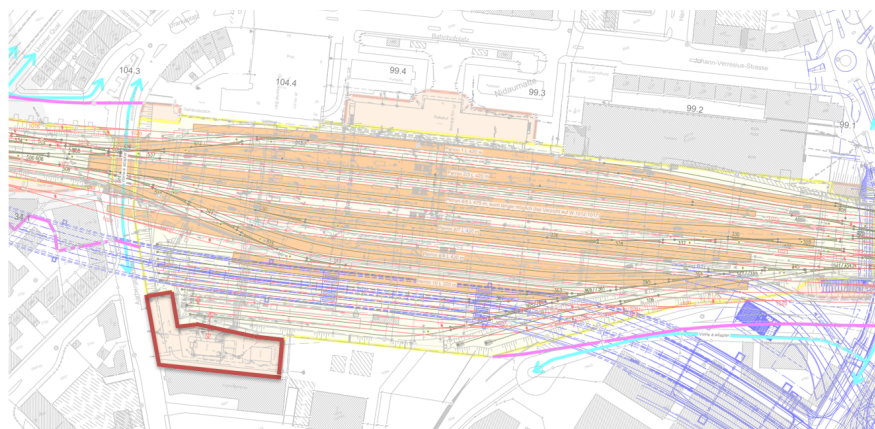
Plan des réservations de tracé (SBB, 2016)
